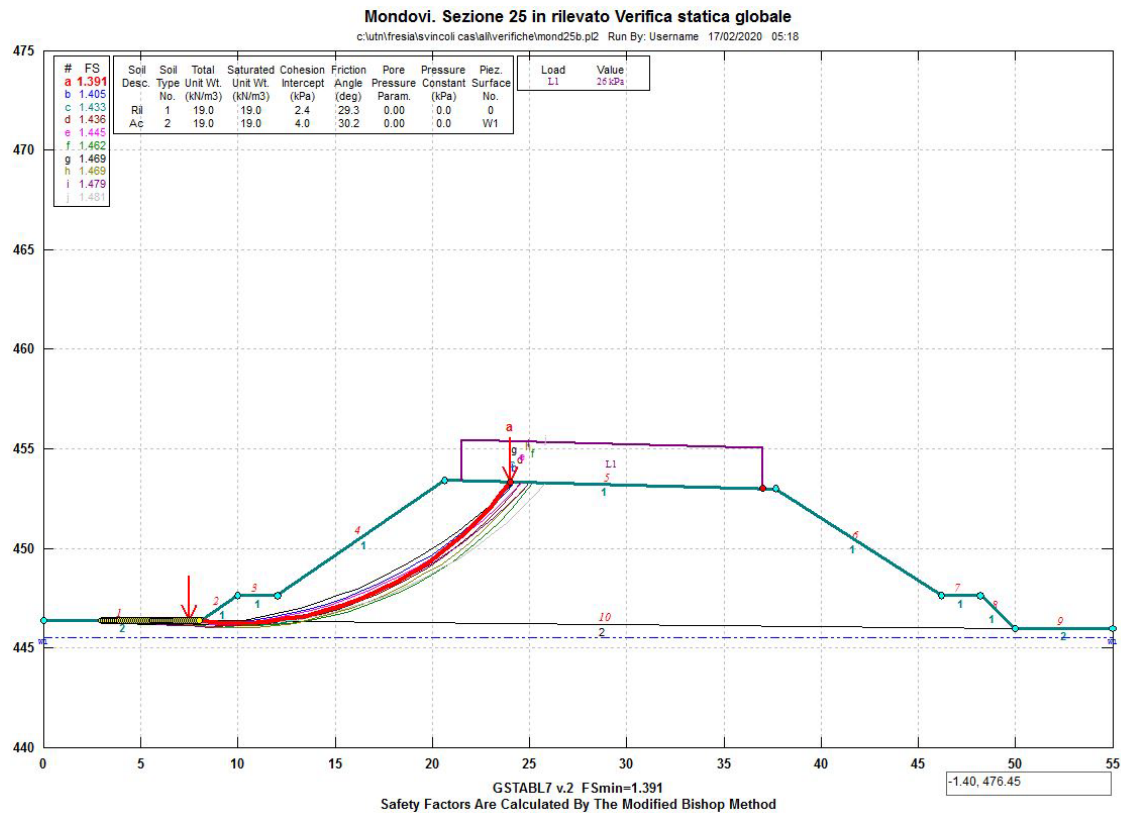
Tratto in rilevato. Sezione 25. Verifica statica globale $F_s = 1,391$
